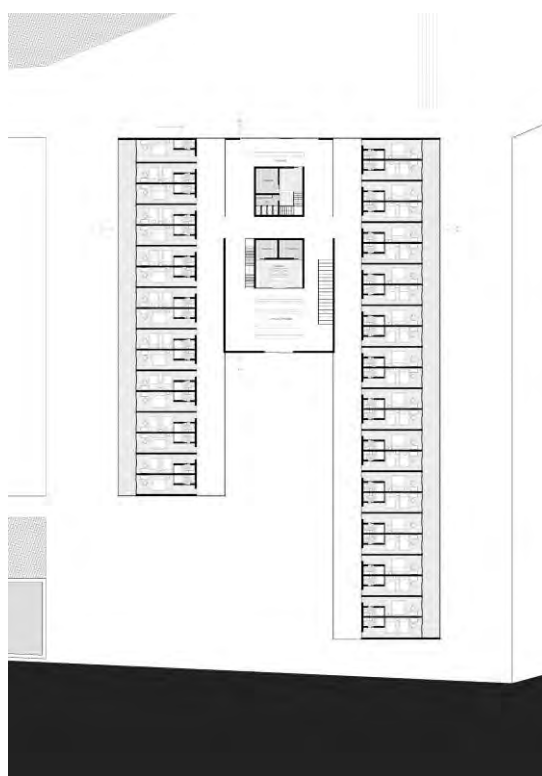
Desenho em planta piso térreo, hotel duas estrelas. (Ilustração nossa, 2011)
